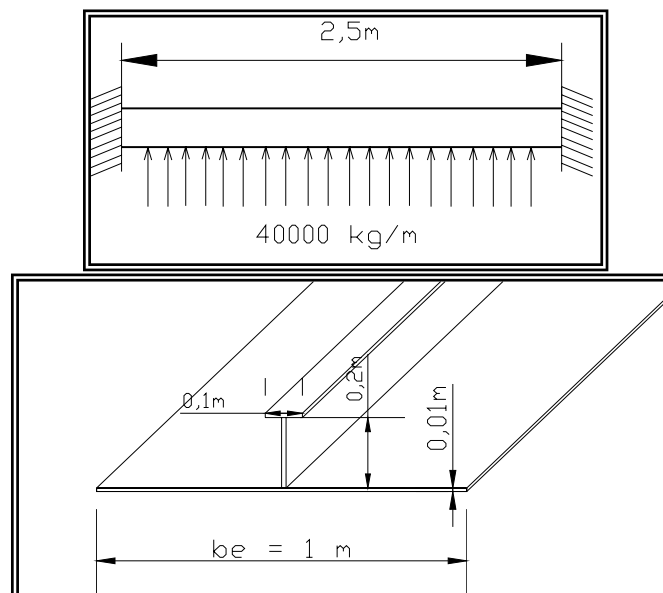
Modelo esquemático del refuerzo con su carga e plancha efectiva
